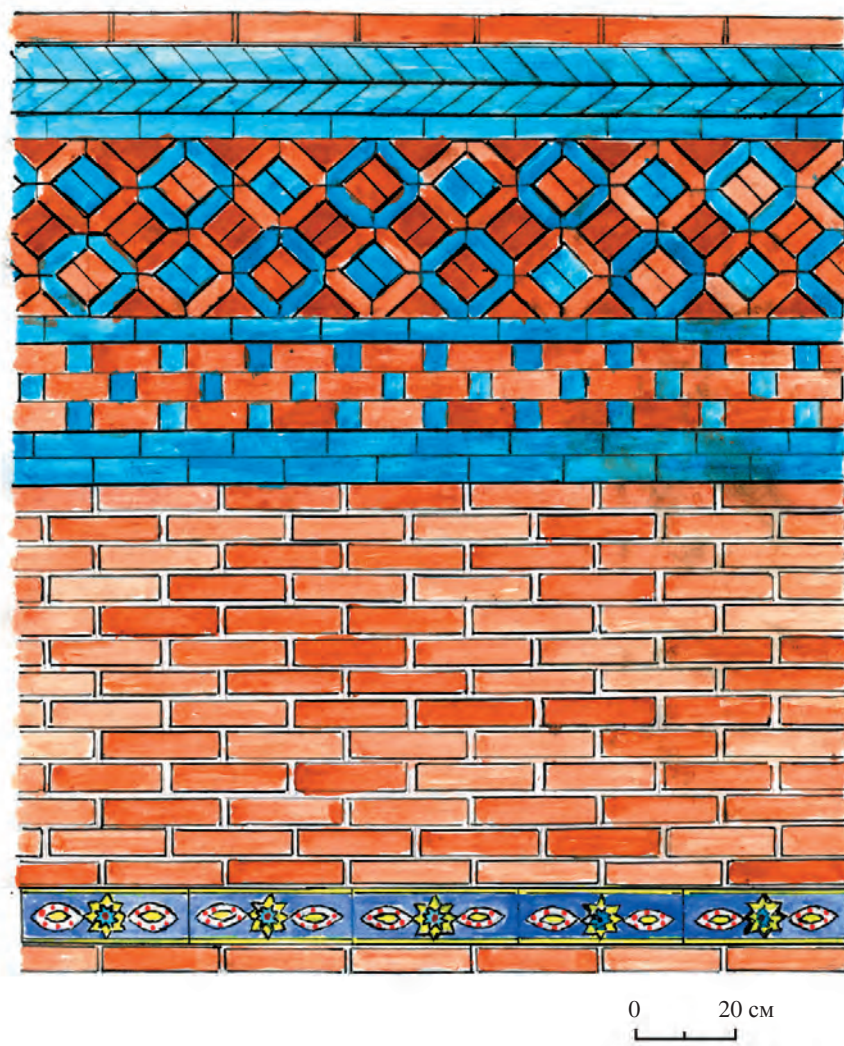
Дворцовое здание 1. Фриз (реконструкция)
